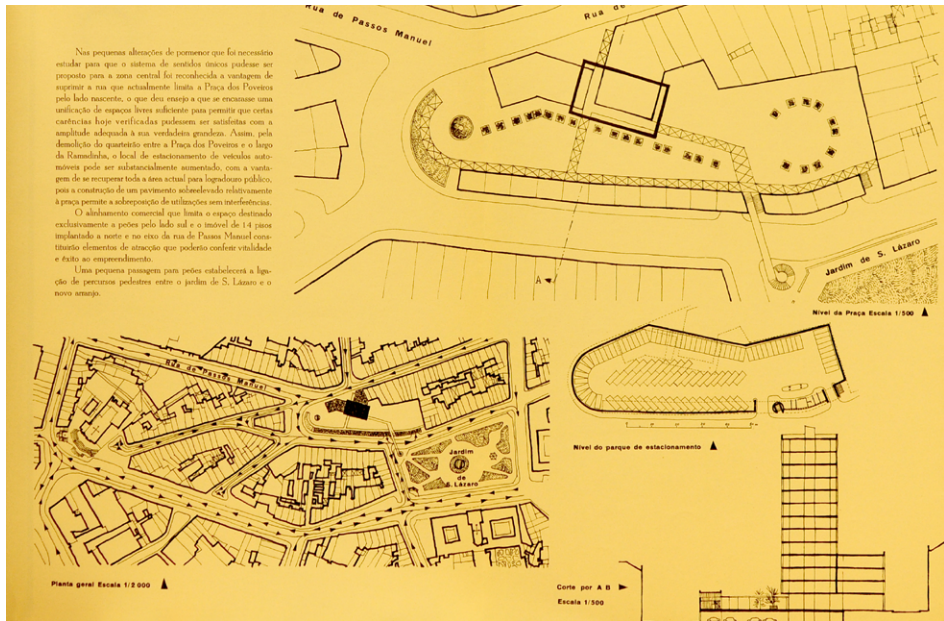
Arranjo da Praça dos Poveiros - Plano Diretor.
